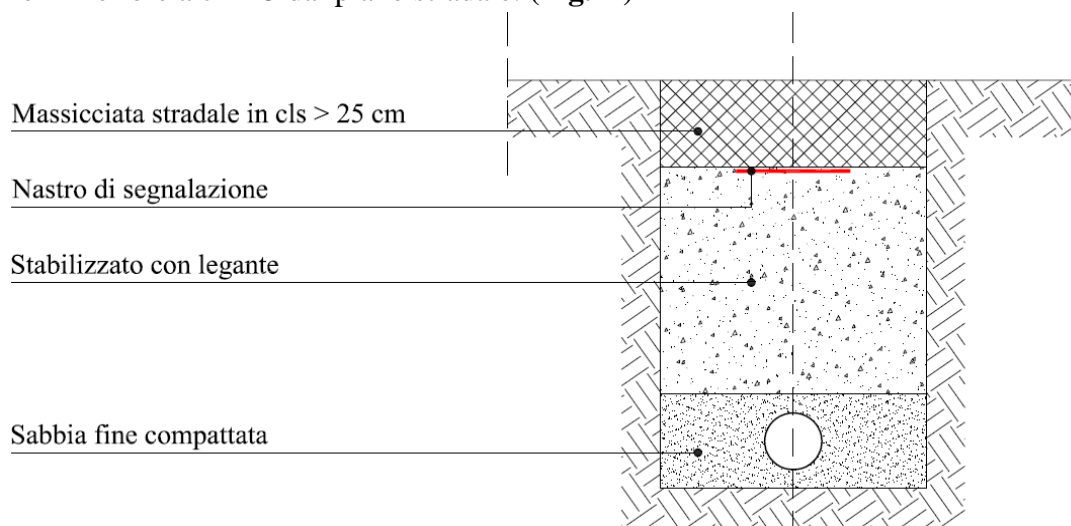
Fig. A – Sezione tipo scavo/ripristino tradizionale provvisorio su strada bitumata
